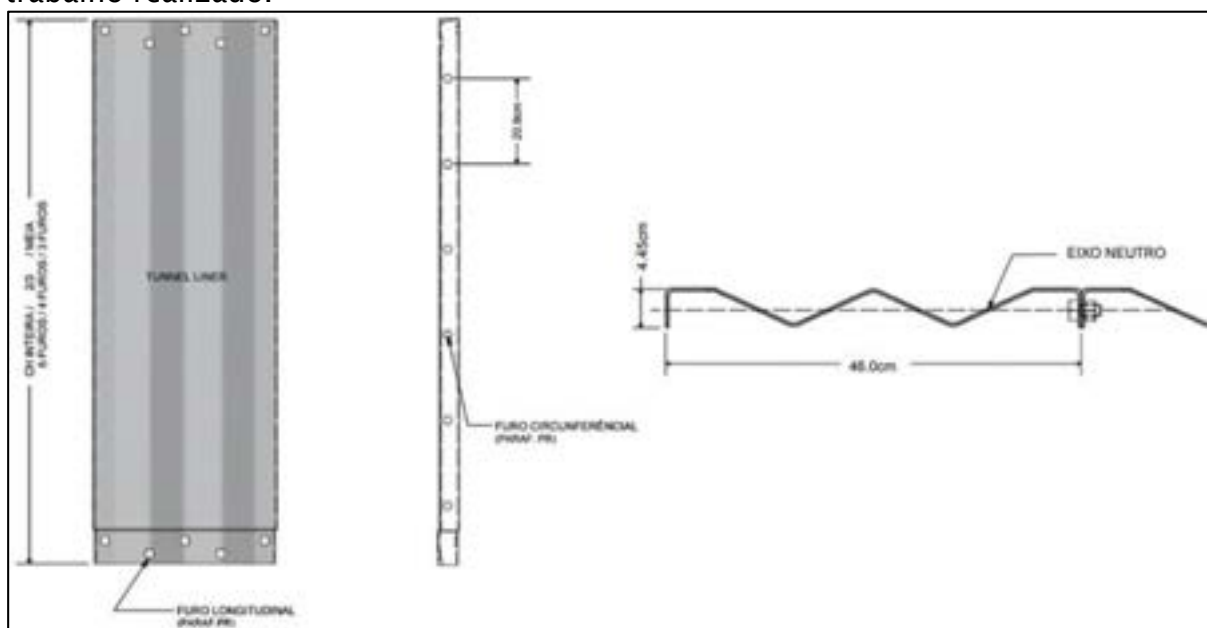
Esquemático da montagem sugerido de chapas metálicas
